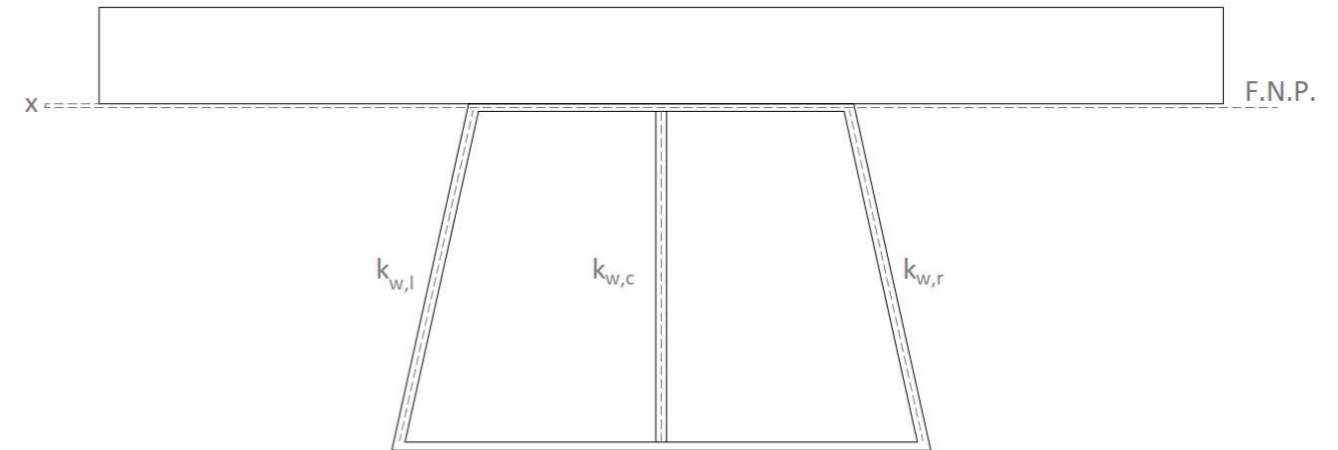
Fibra neutra plástica en el ala superior de la viga longitudinal (fuente: elaboración propia)
